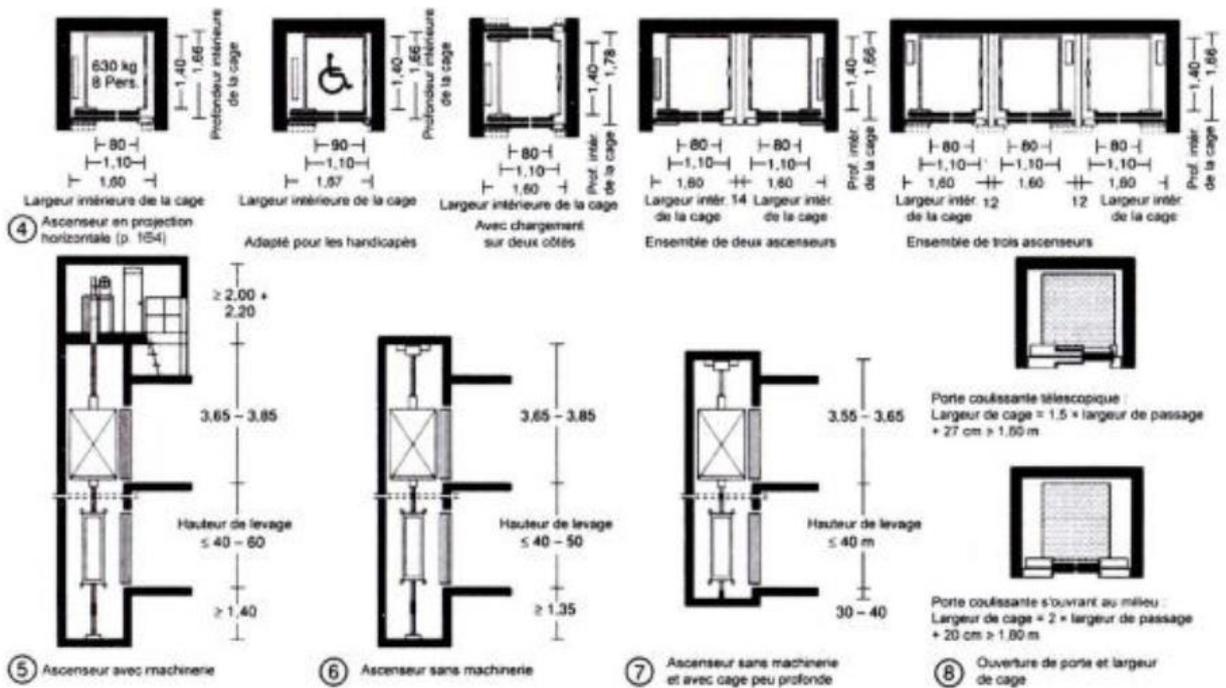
Les dimensions en coupe et en plan des cages d'ascenseur standard.
